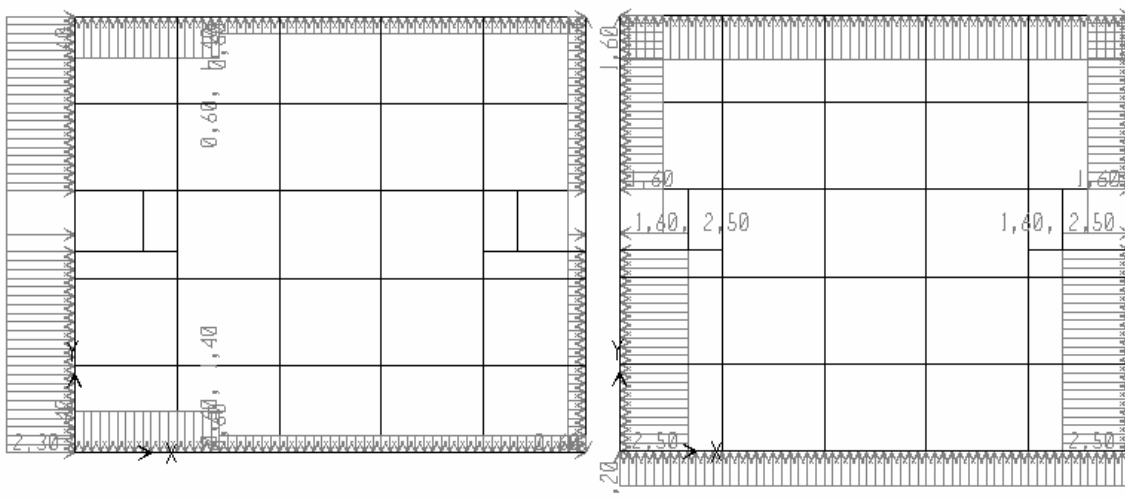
Carregamento de vento do 6º ao 9º pavimento nas direções x e y.
